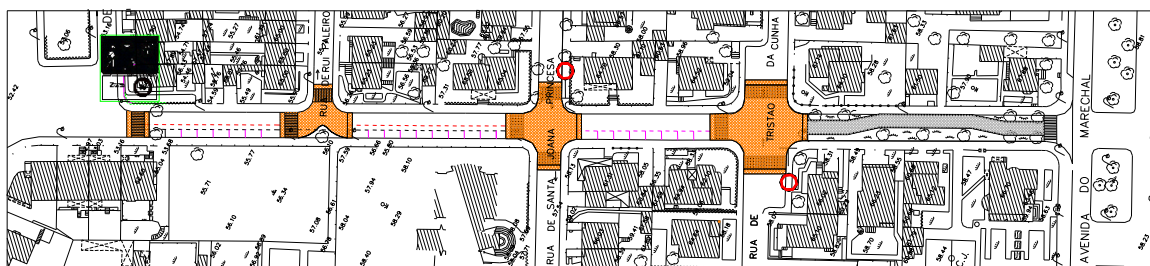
Planta geral das alterações que se pretende aplicar no cenário nº.2
